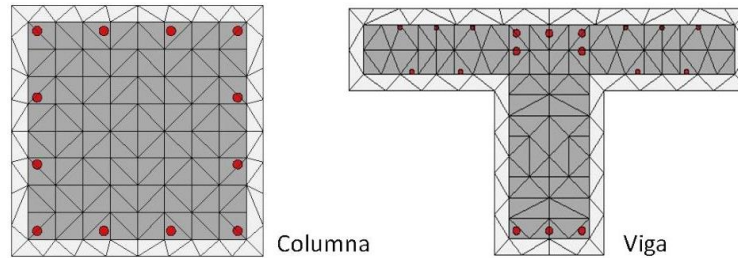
Secciones utilizadas en columnas y vigas con 200 fibras (Seismosoft SRL, 2014)
